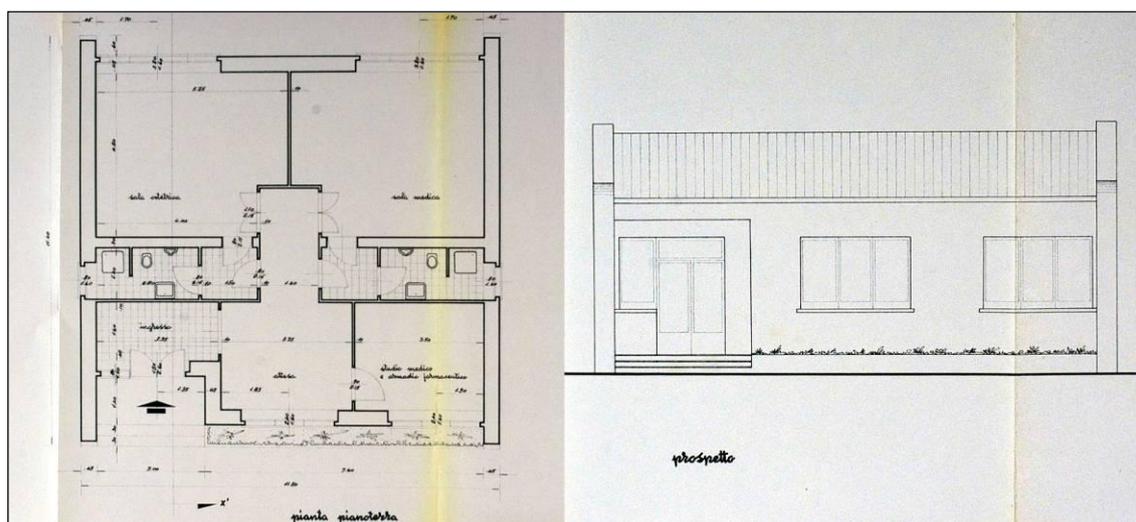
Pianta e prospetto dell'ambulatorio del borgo di Serramarina (MT) – Archivio ERSAP
